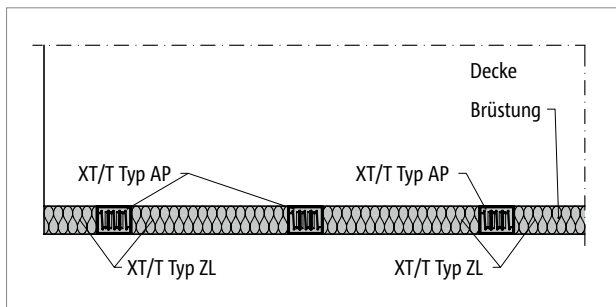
Schöck Isokorb® XT/T Typ AP vertikale Anordnung: Grundriss Brüstung aufgesetzt
